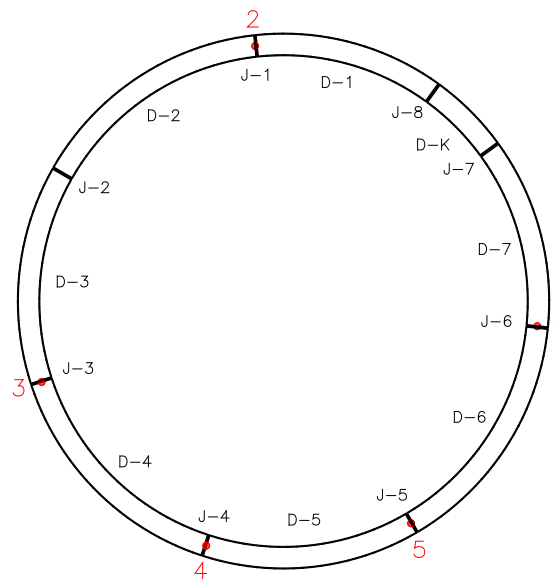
Mecanismo de colapso de un anillo aislado sin revestimiento secundario.
